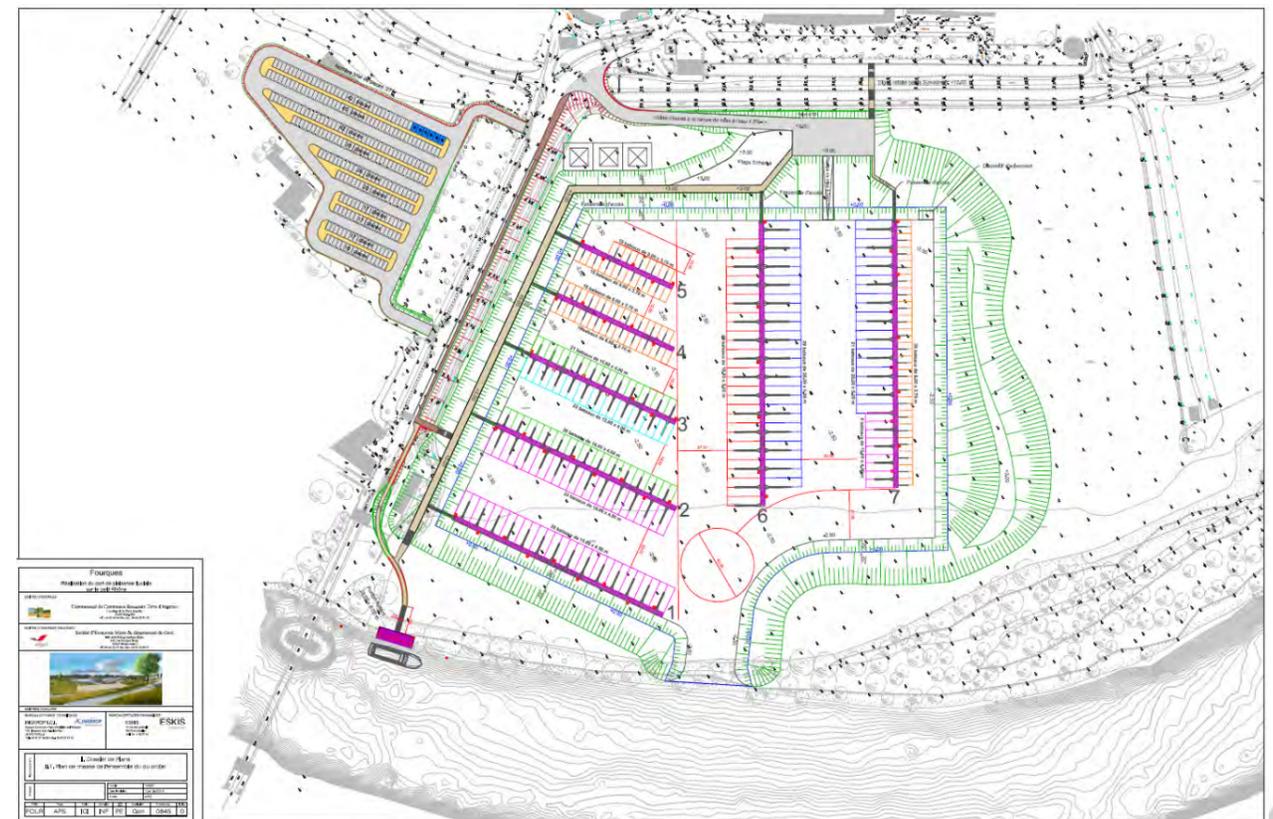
Plan de masse du projet au stade APS (source : Ingerop)
